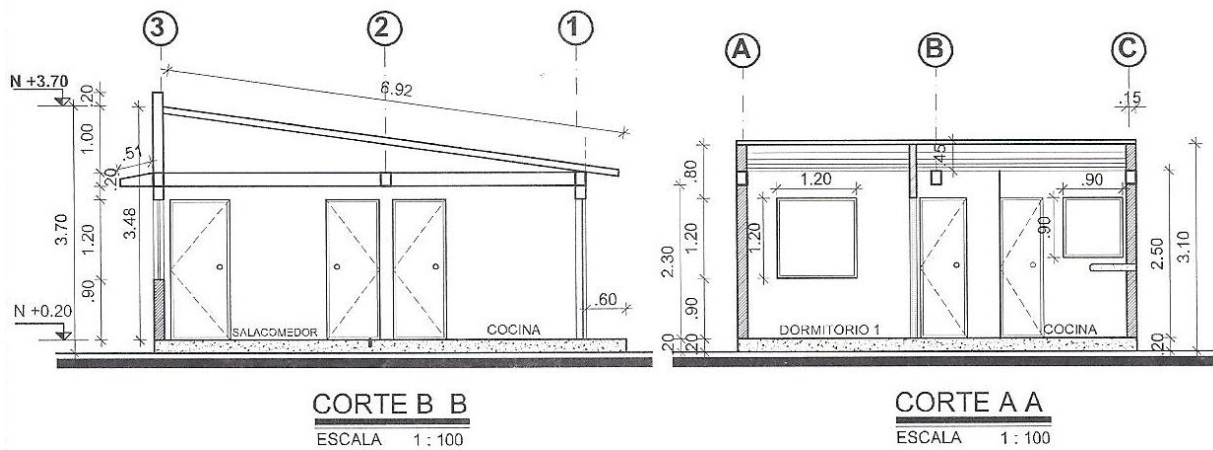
Concepción de las fachadas. Cortes A-A Y Cortes B-B
